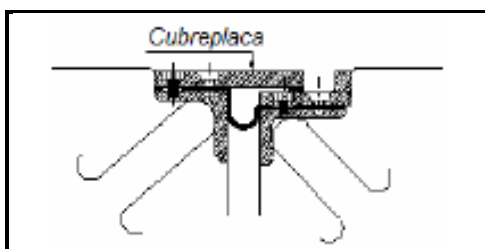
Junta de placa de acero deslizante. (Fuente: Manual de Inspección de puentes, 2007)
